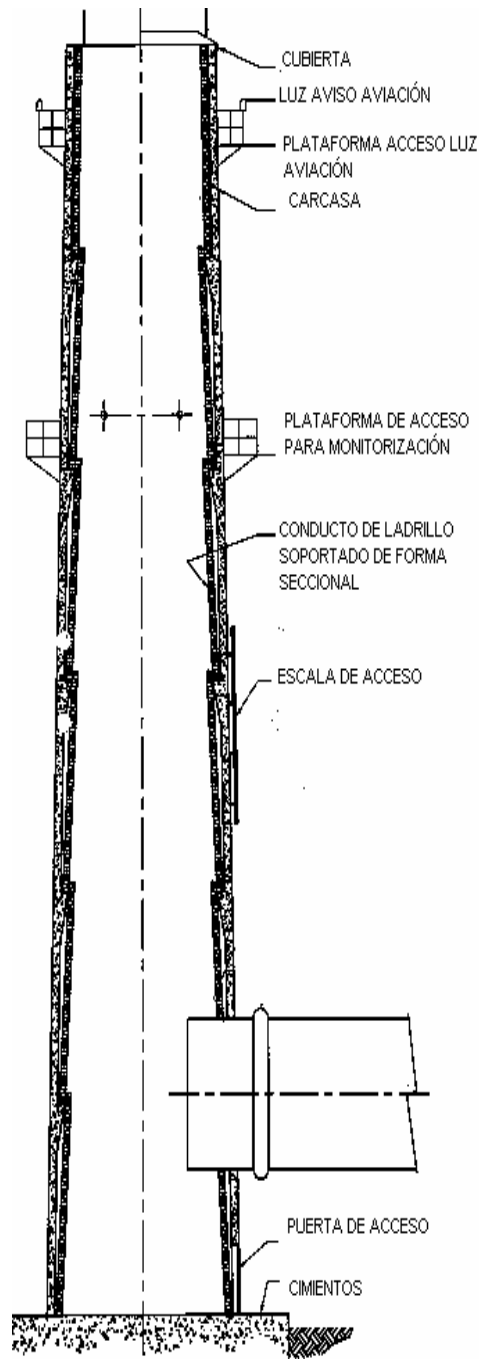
Chimenea de hormigón con conducto de ladrillo soportado de forma seccional
